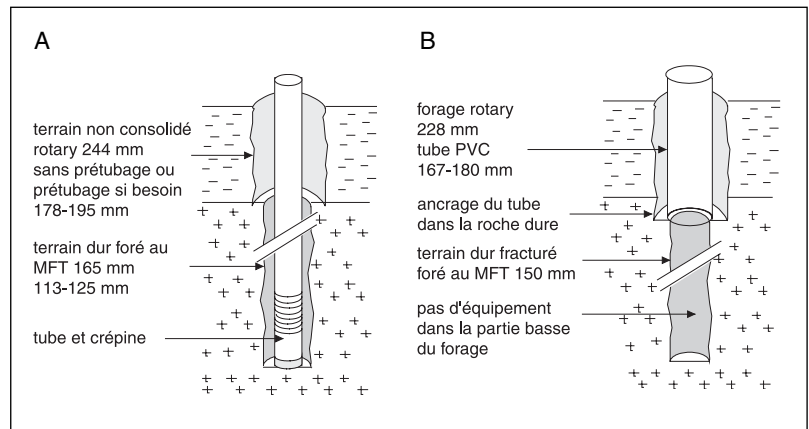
Forage mixte rotary et marteau fond de trou. A, équipement complet. B, équipement des terrains non consolidés uniquement.
